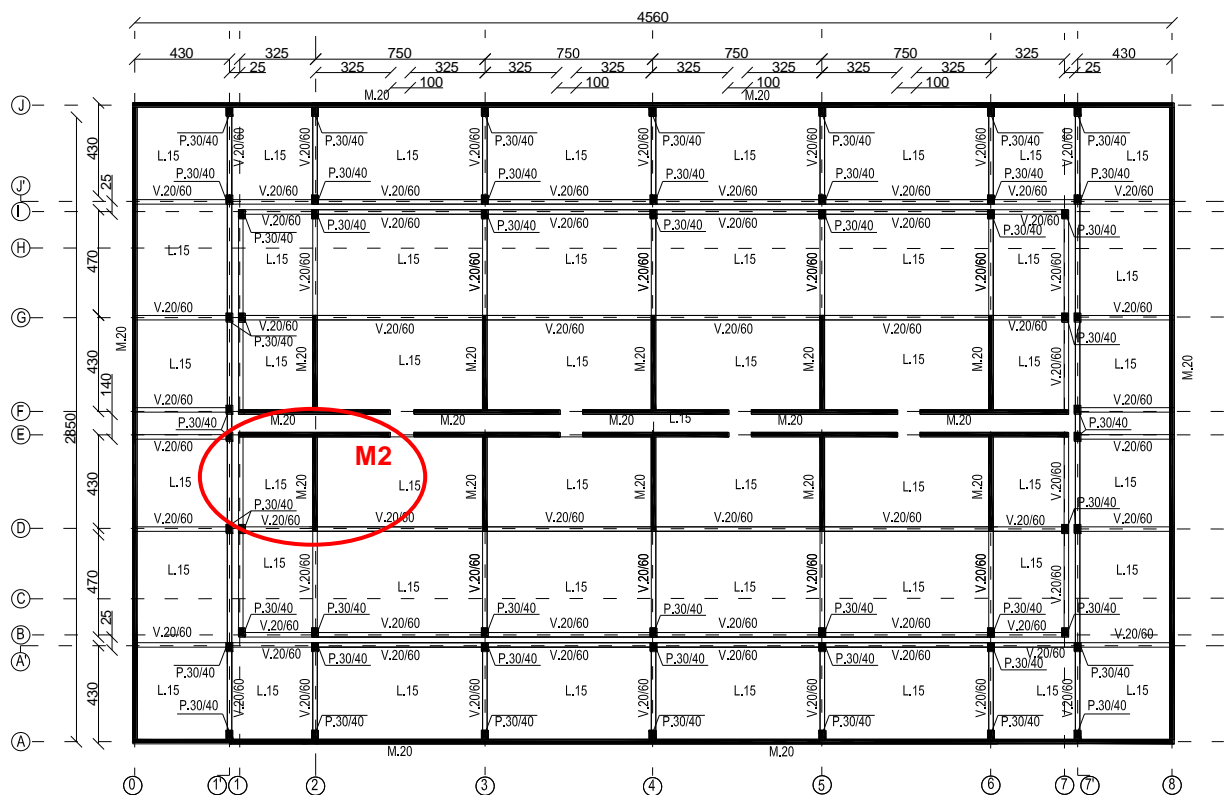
Identificación de muro a diseñar en estructura aislada.
